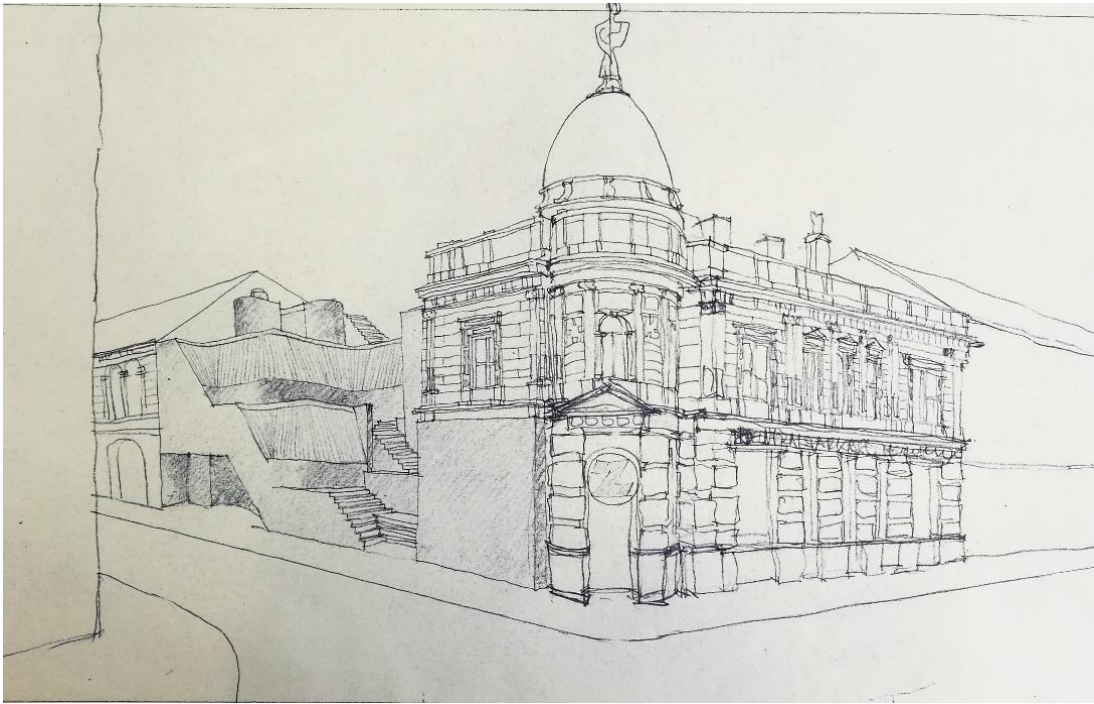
Plan Nr. 8, Erweiterung durch Zubau, Hans Hollein, 1966
